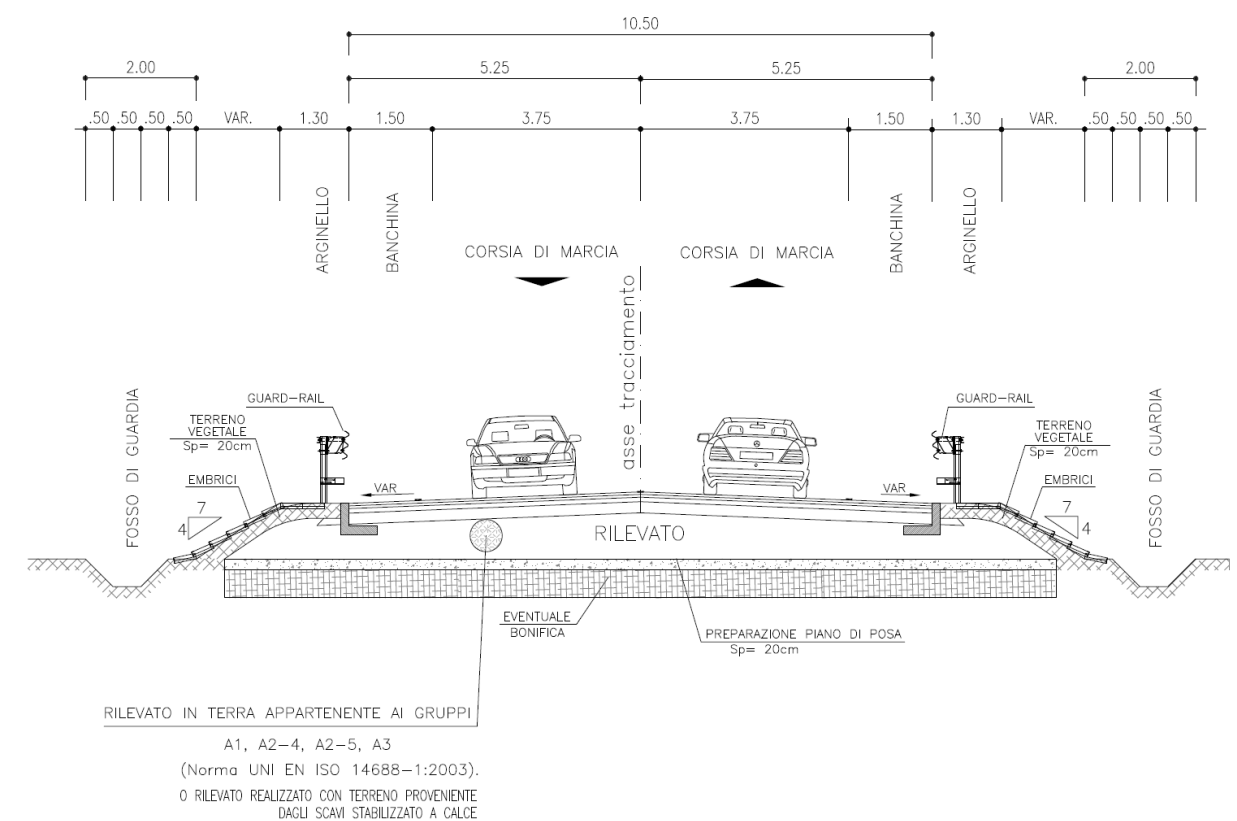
Sezione tipo rampa bidirezionale in rilevato
